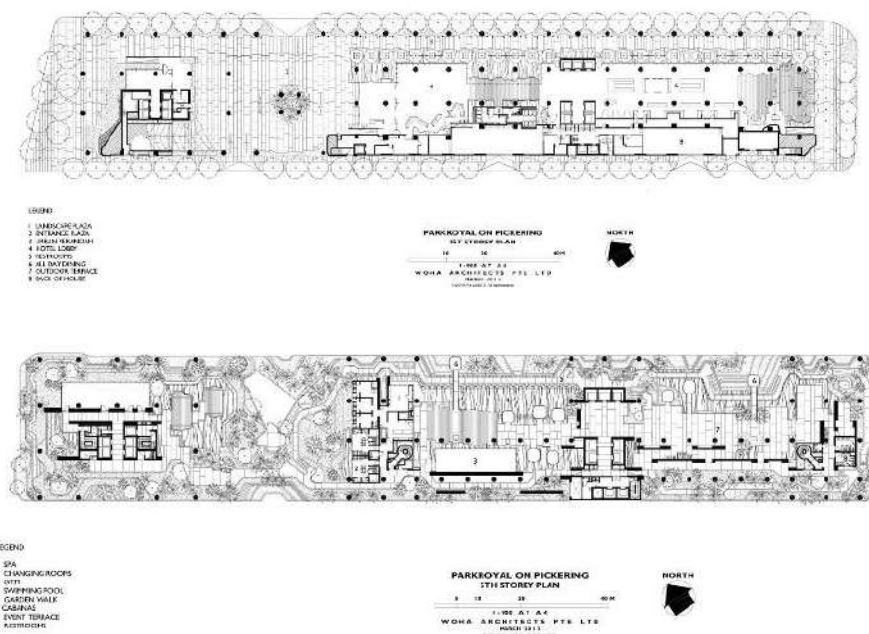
План 1го и 5го этажей отеля ParkRoyal
